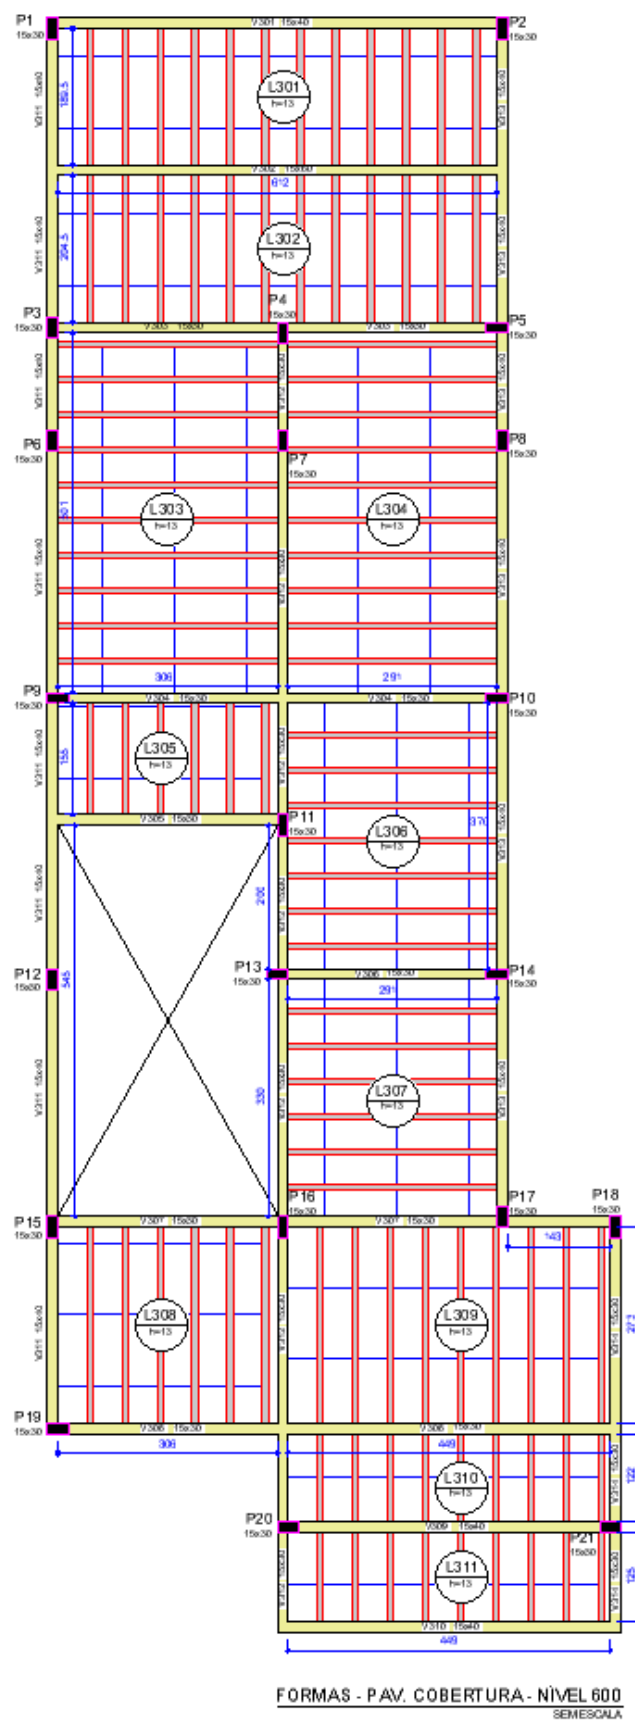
Planta de formas do pavimento cobertura do modelo de lajes maciças.
